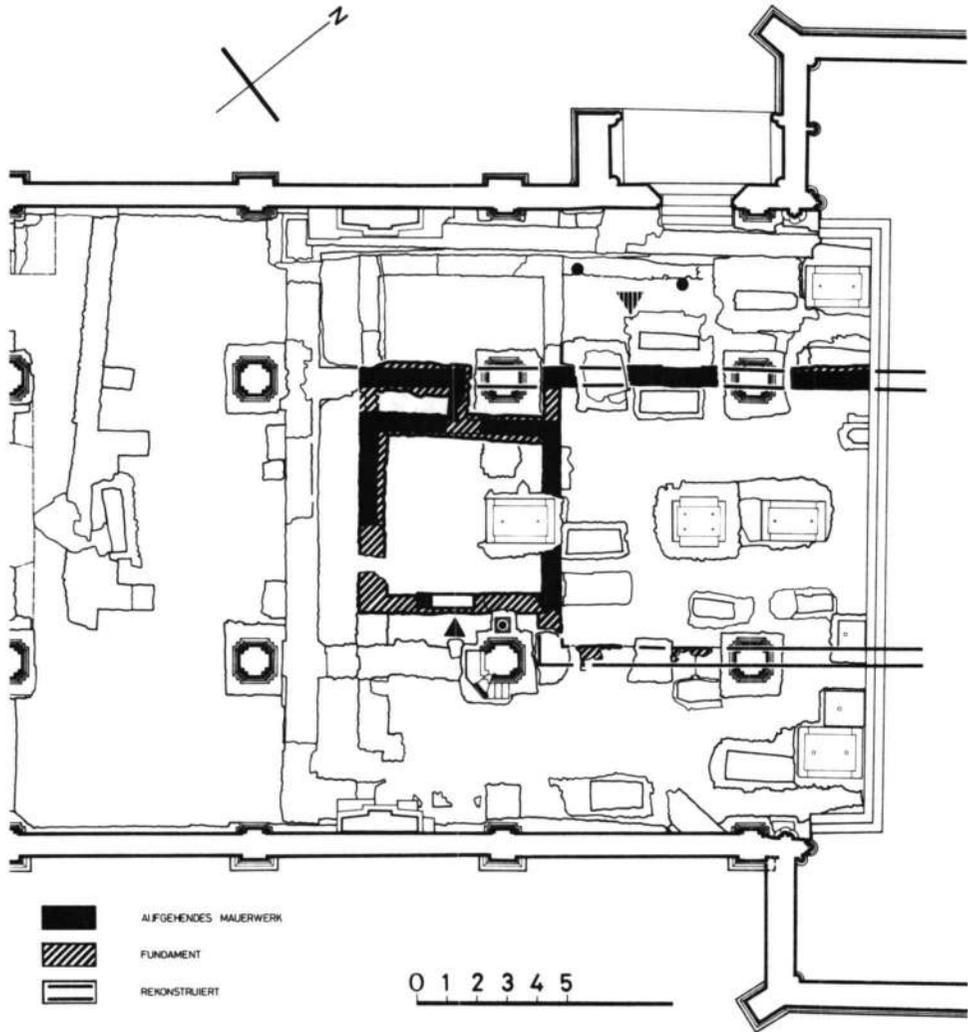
Anlage II: rekonstruierter Grundriss (Massstab 1 : 250).
